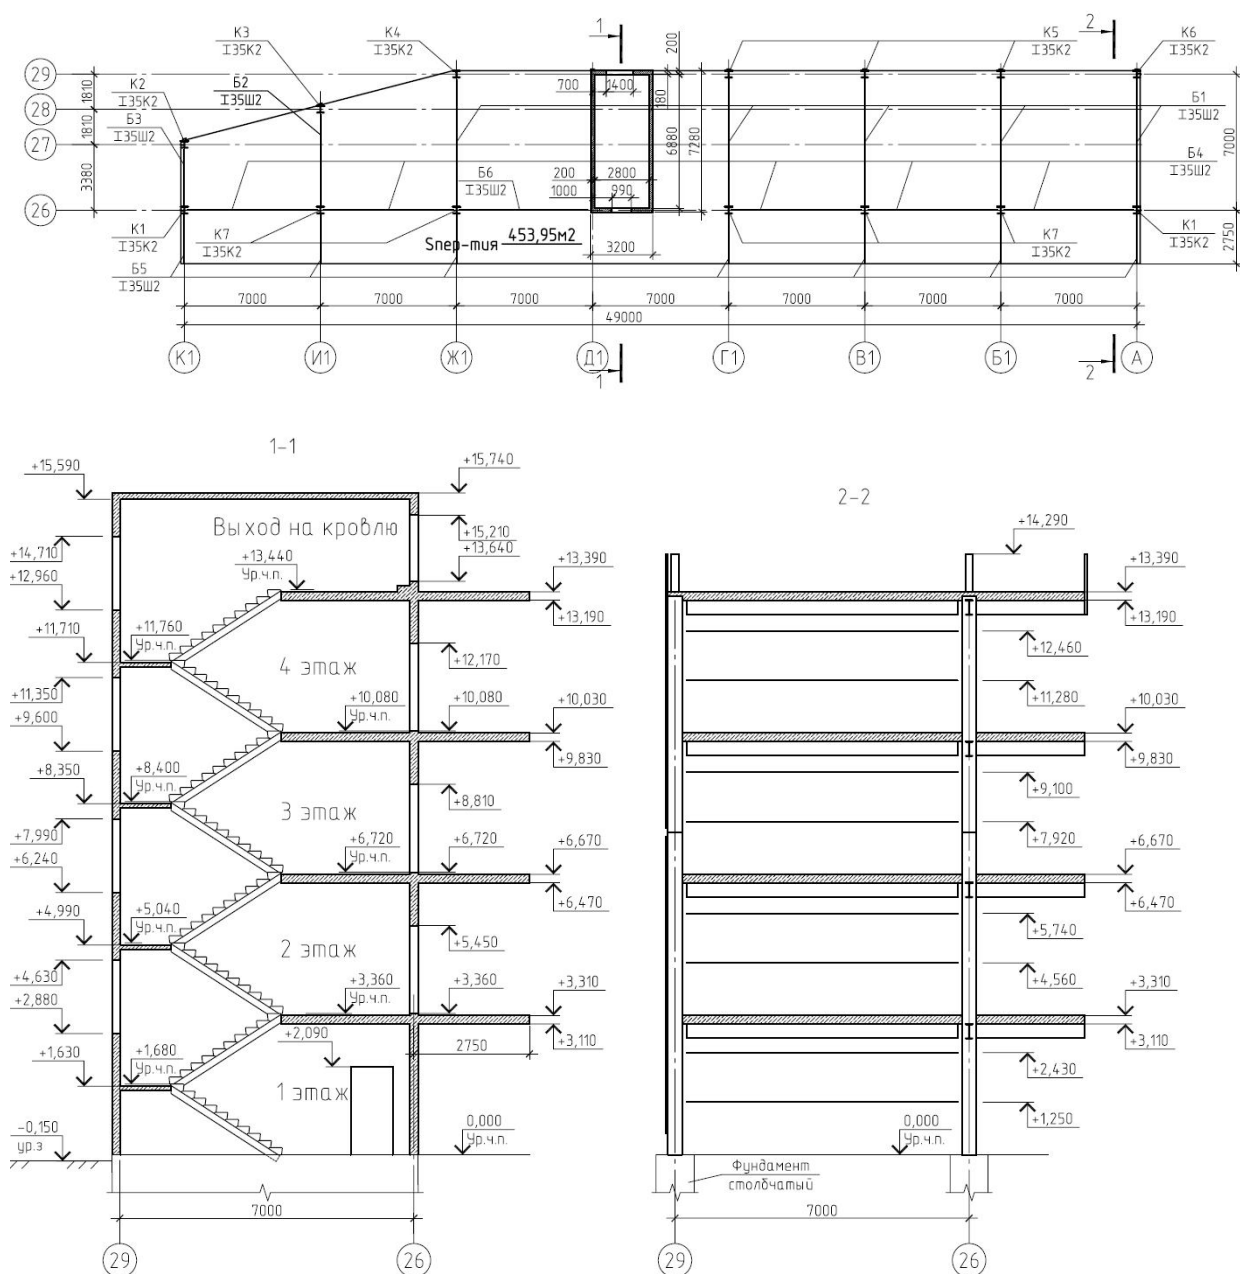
Стальной каркас здания с плоскими монолитными перекрытиями.
